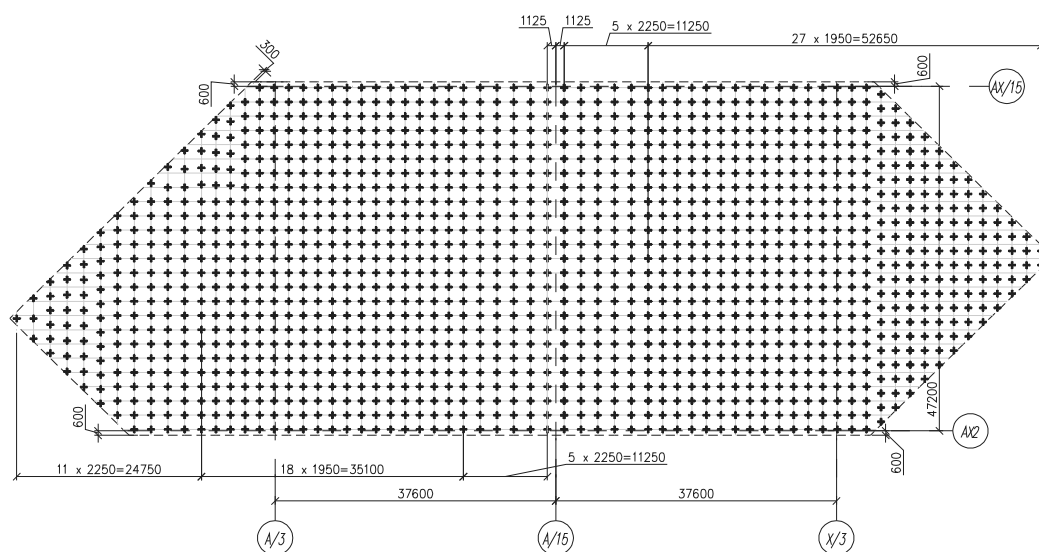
Размещение свай в свайном фундаменте зданий Амир и Хан при регулярном шаге свай
